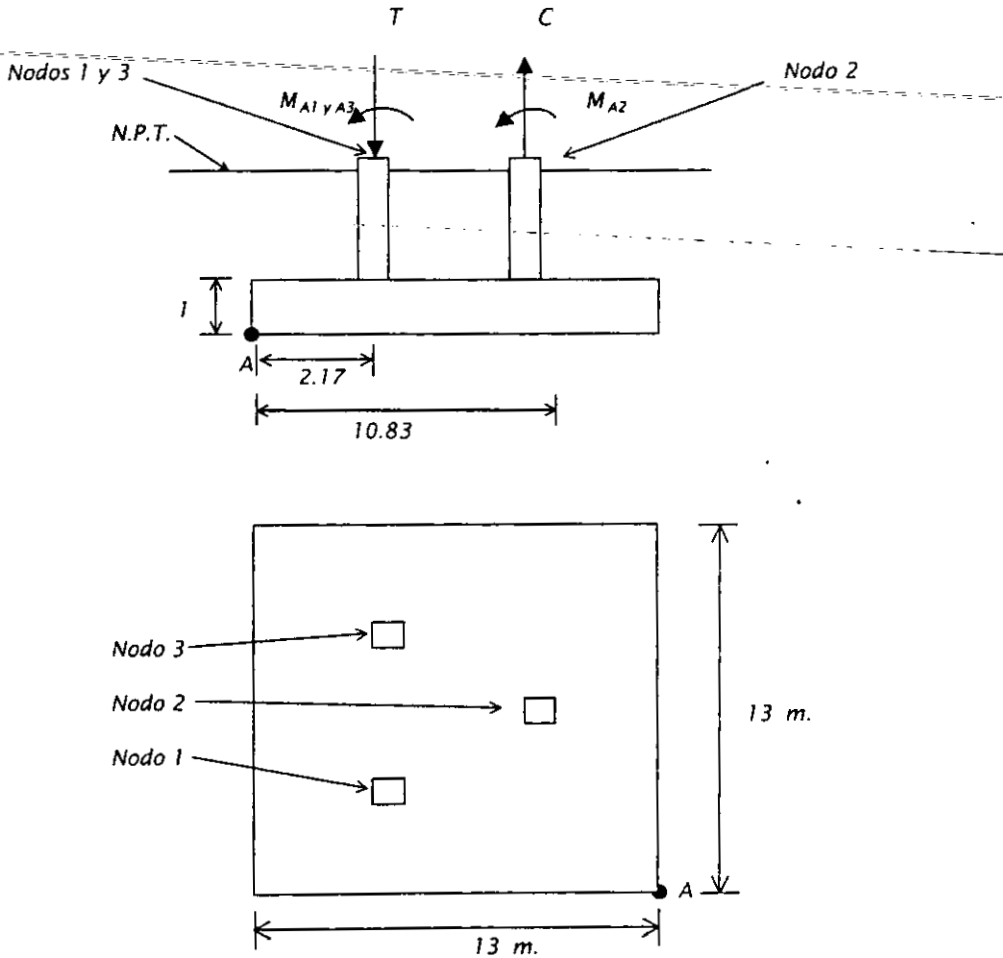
11. Losa en planta y elevación (Unidades en metros).
